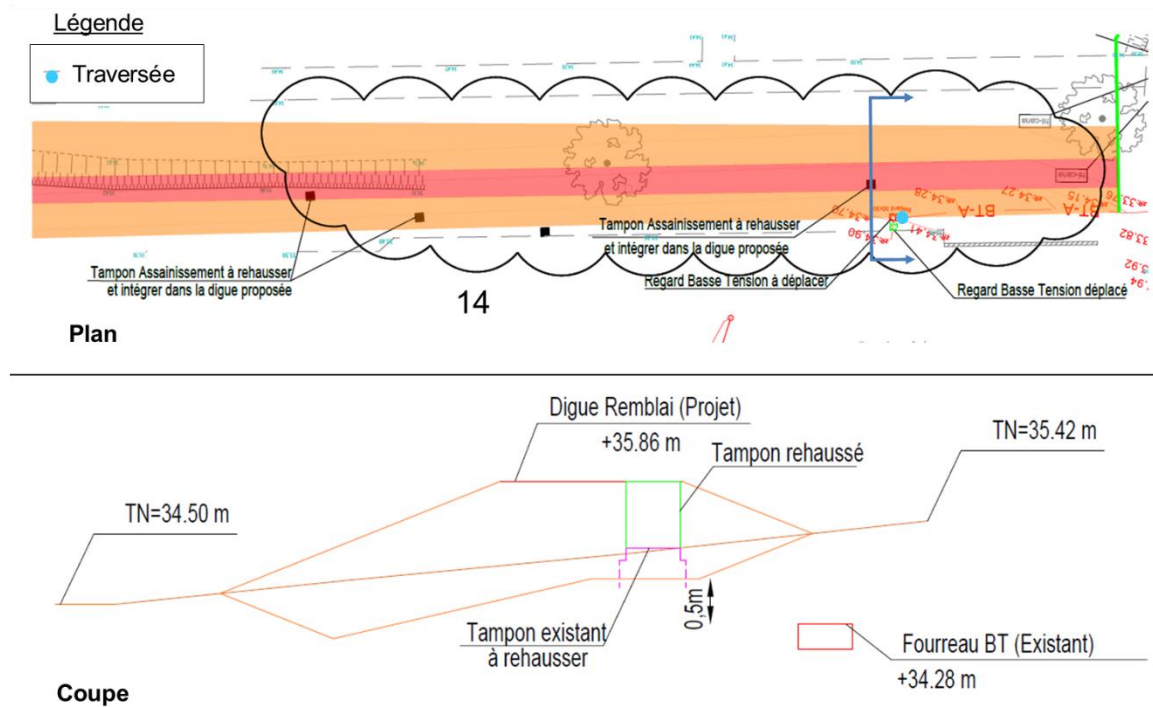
Remblai en chevauchement avec une conduite d'assainissement et traversant un fourreau BT
